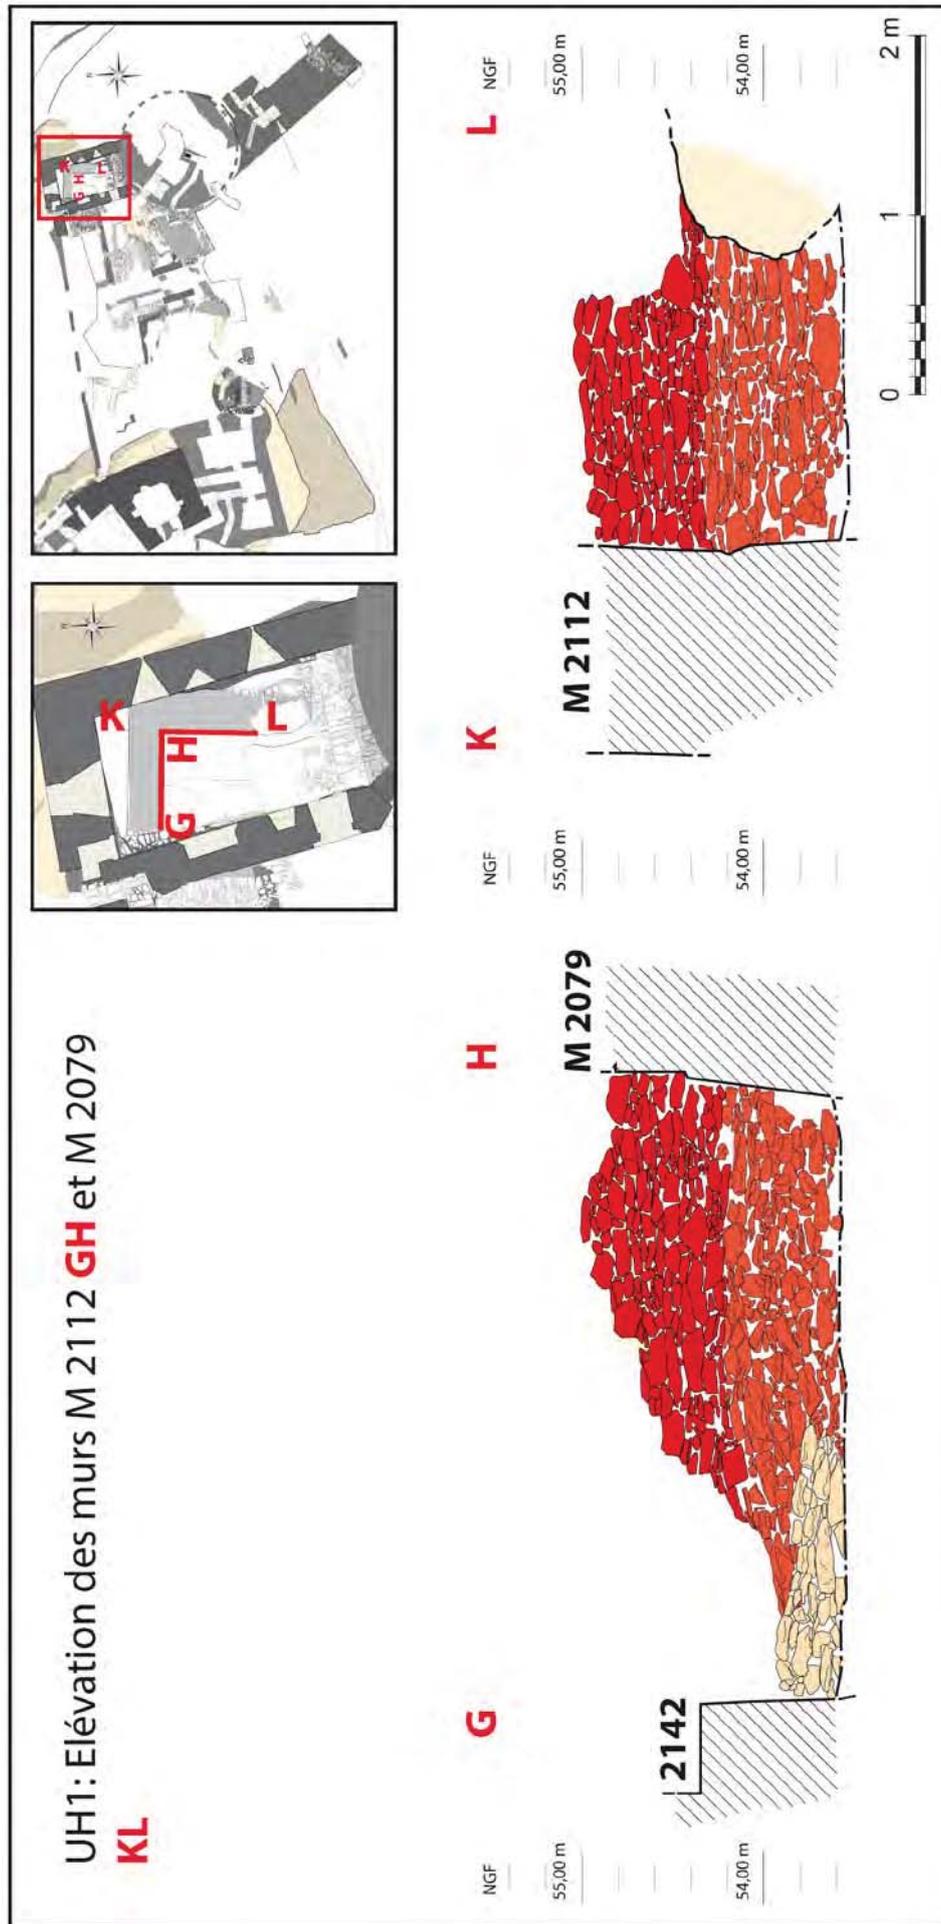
Elévations du parement sud du mur M 2112, et du parement ouest du mur M 2079. DAO E. Lagneau et B. Grall, CD29/ Mission archéologie
